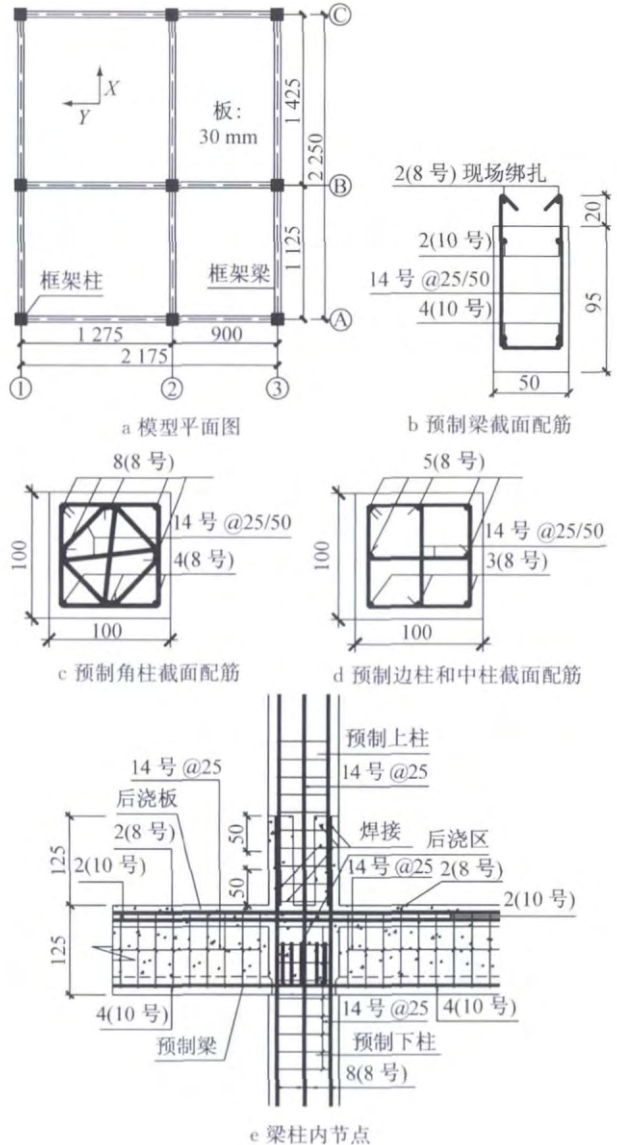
预制再生混凝土框架模型尺寸及配筋(单位: mm)
